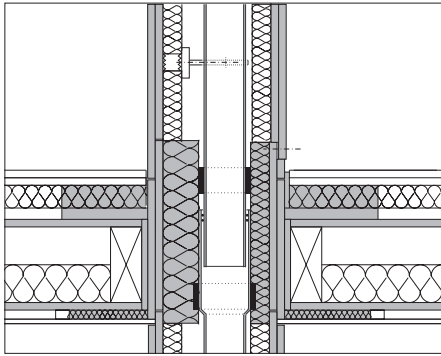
Eingebauter Deckenschott mit oberhalb und unterhalb angeordnetem vertikal Schacht
